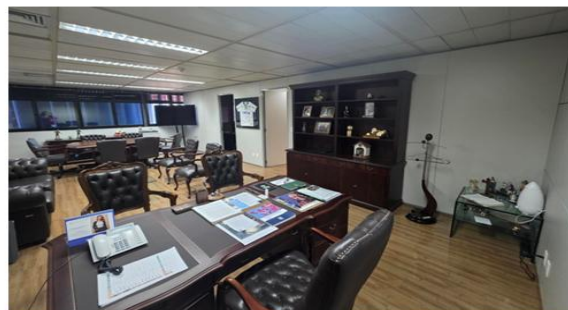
Vista geral do Gabinete - Detalhes para paredes e forro
